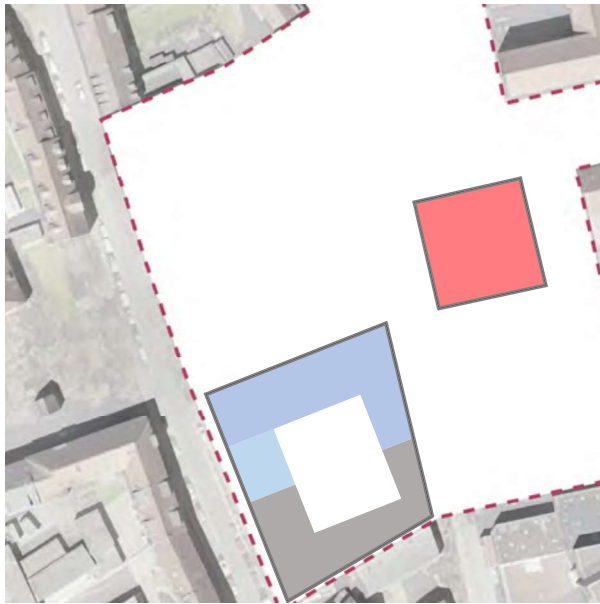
Grundriss UG Großer Hof V2
